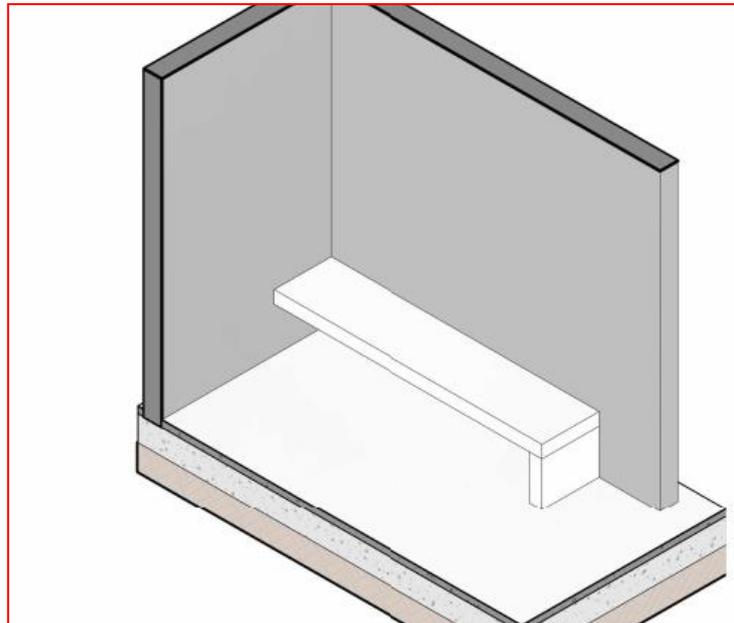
Banco de Concreto moldado in-loco - Fonte: CEASA/PR e AUEN
